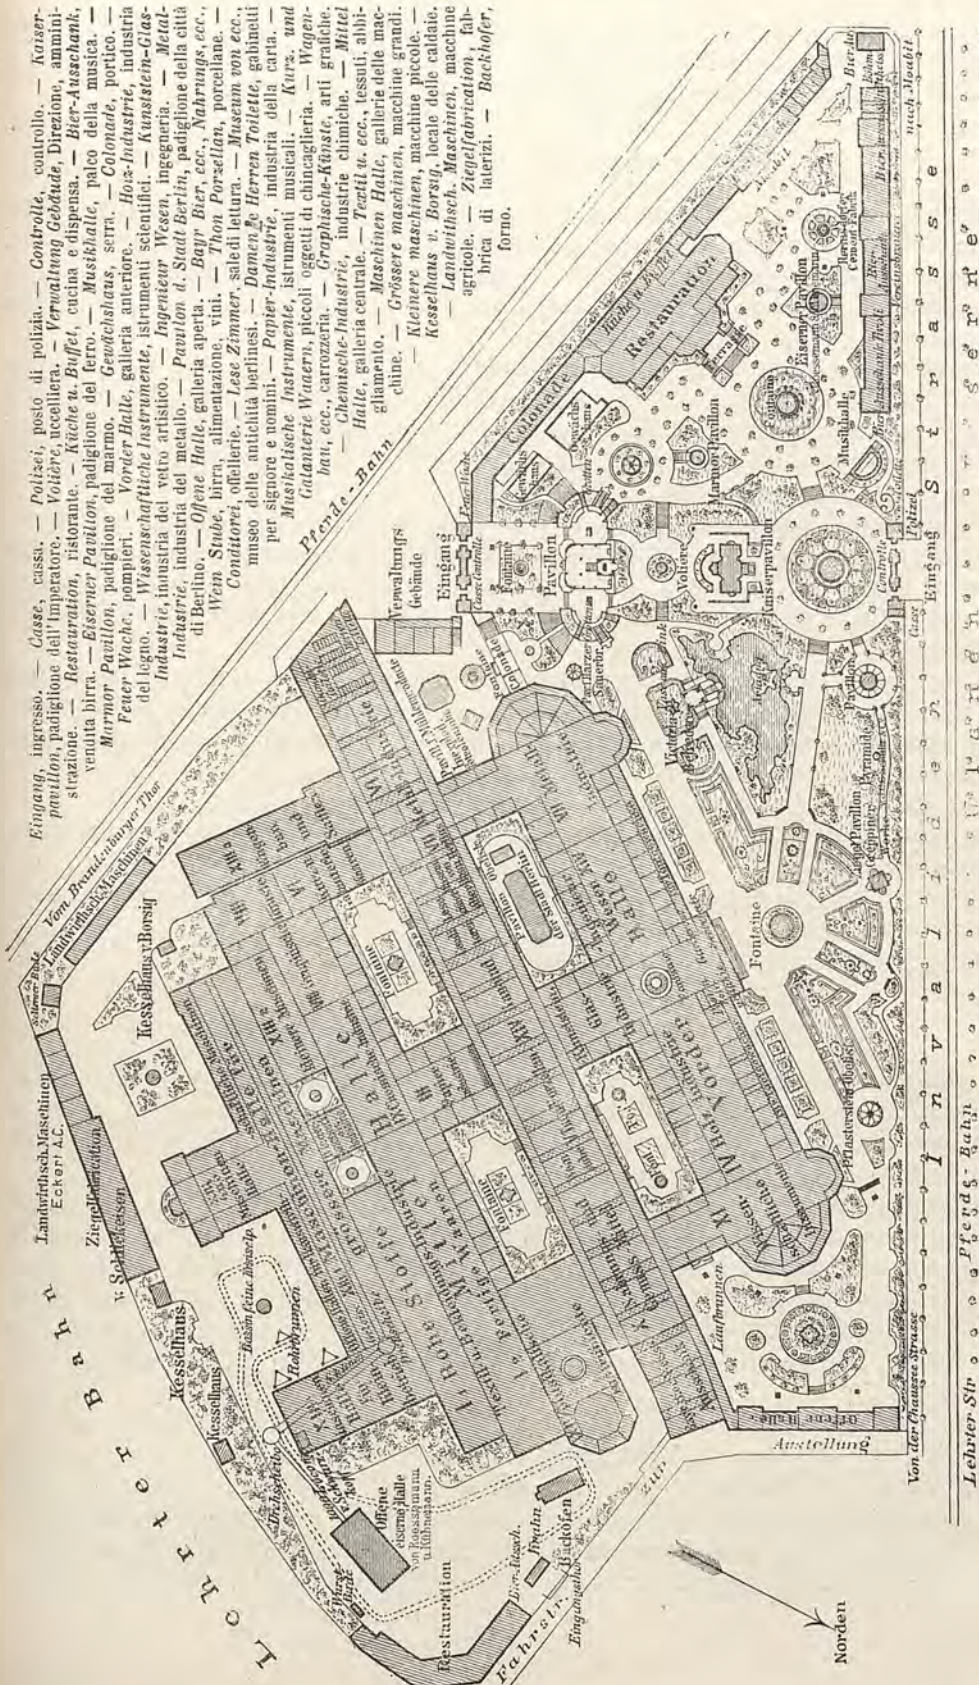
Planimetria generale dell'Esposizione industriale di Berlino del 1879.
